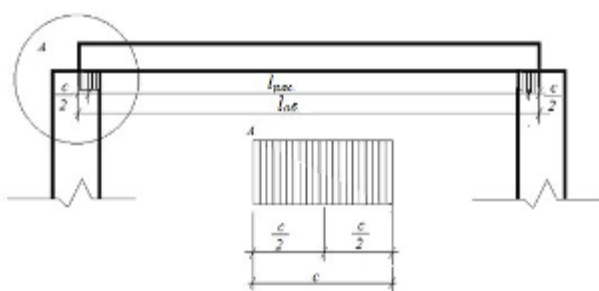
Вид распределения нагрузок по закону четырехугольника при расчете части, которая опирается на стены. А-эпюра распределения напряжений опорного узла
